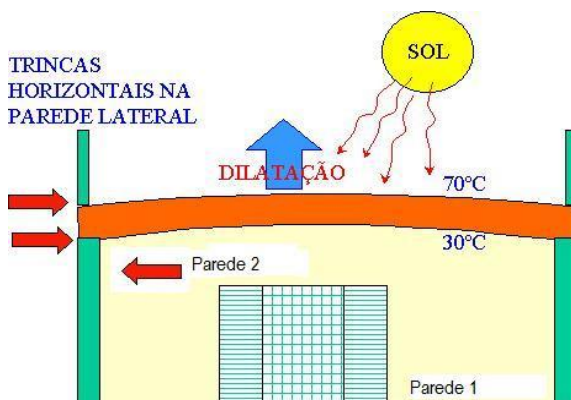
Fissura horizontal causada por movimentação térmica da laje de cobertura
